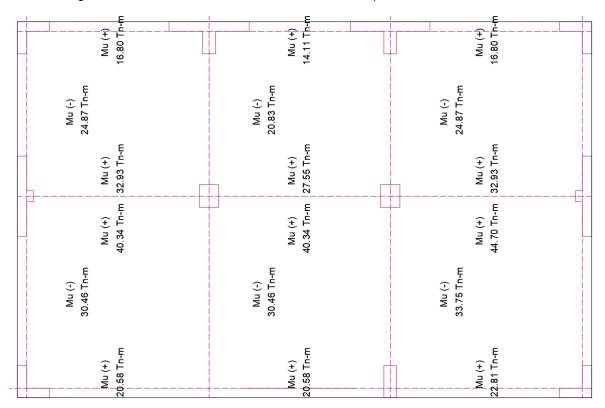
Momentos flectores en la dirección Y-Y para la losa de cimentación.
